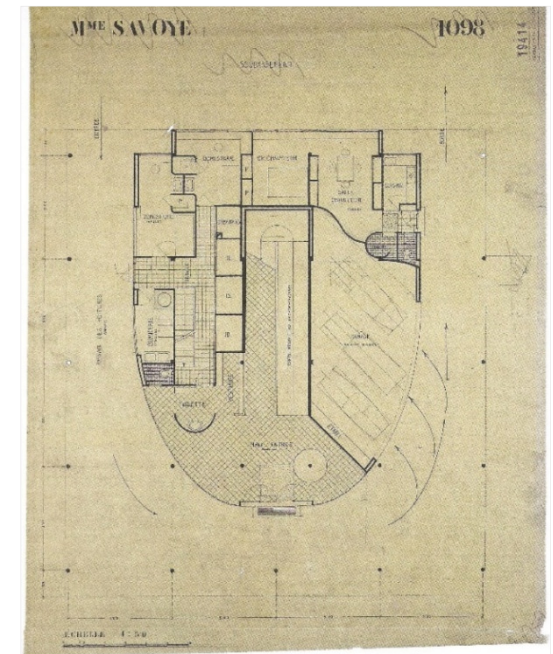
Vila Savoye, primeira proposta. Planta do pavimento térreo. Fonte: Fundação Le Corbusier
